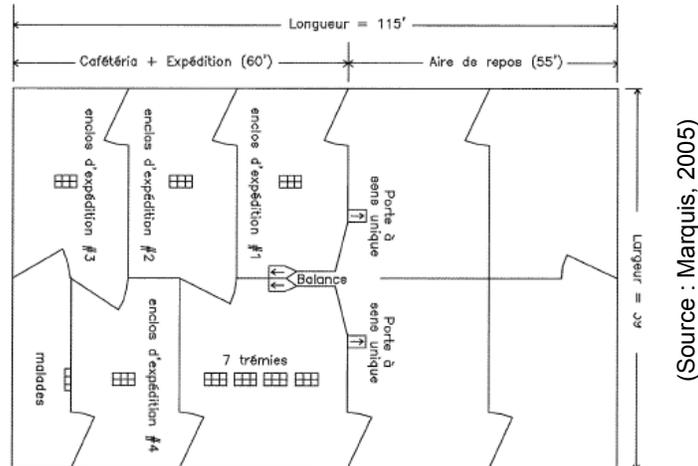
Plan d'aménagement d'un parc en grand groupe offrant de la flexibilité pour l'expédition
